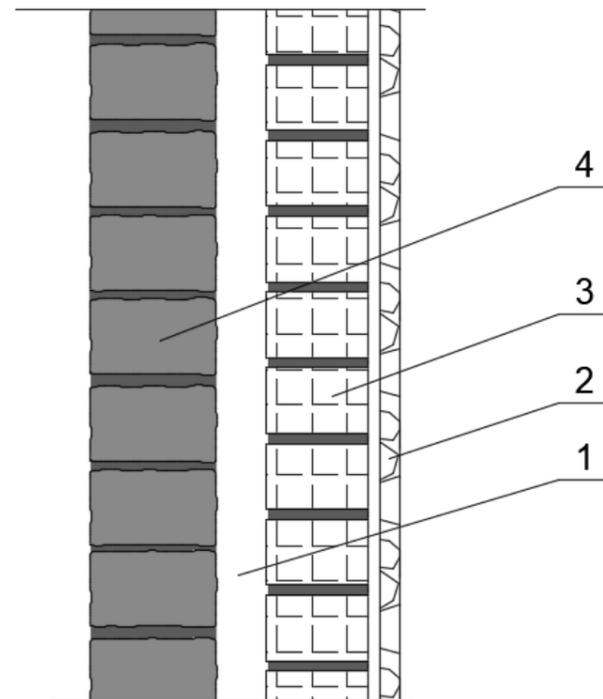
Estación Central de Amberes. Recreación muro fachada. Fuente: Propia. Escala: 1:20.
